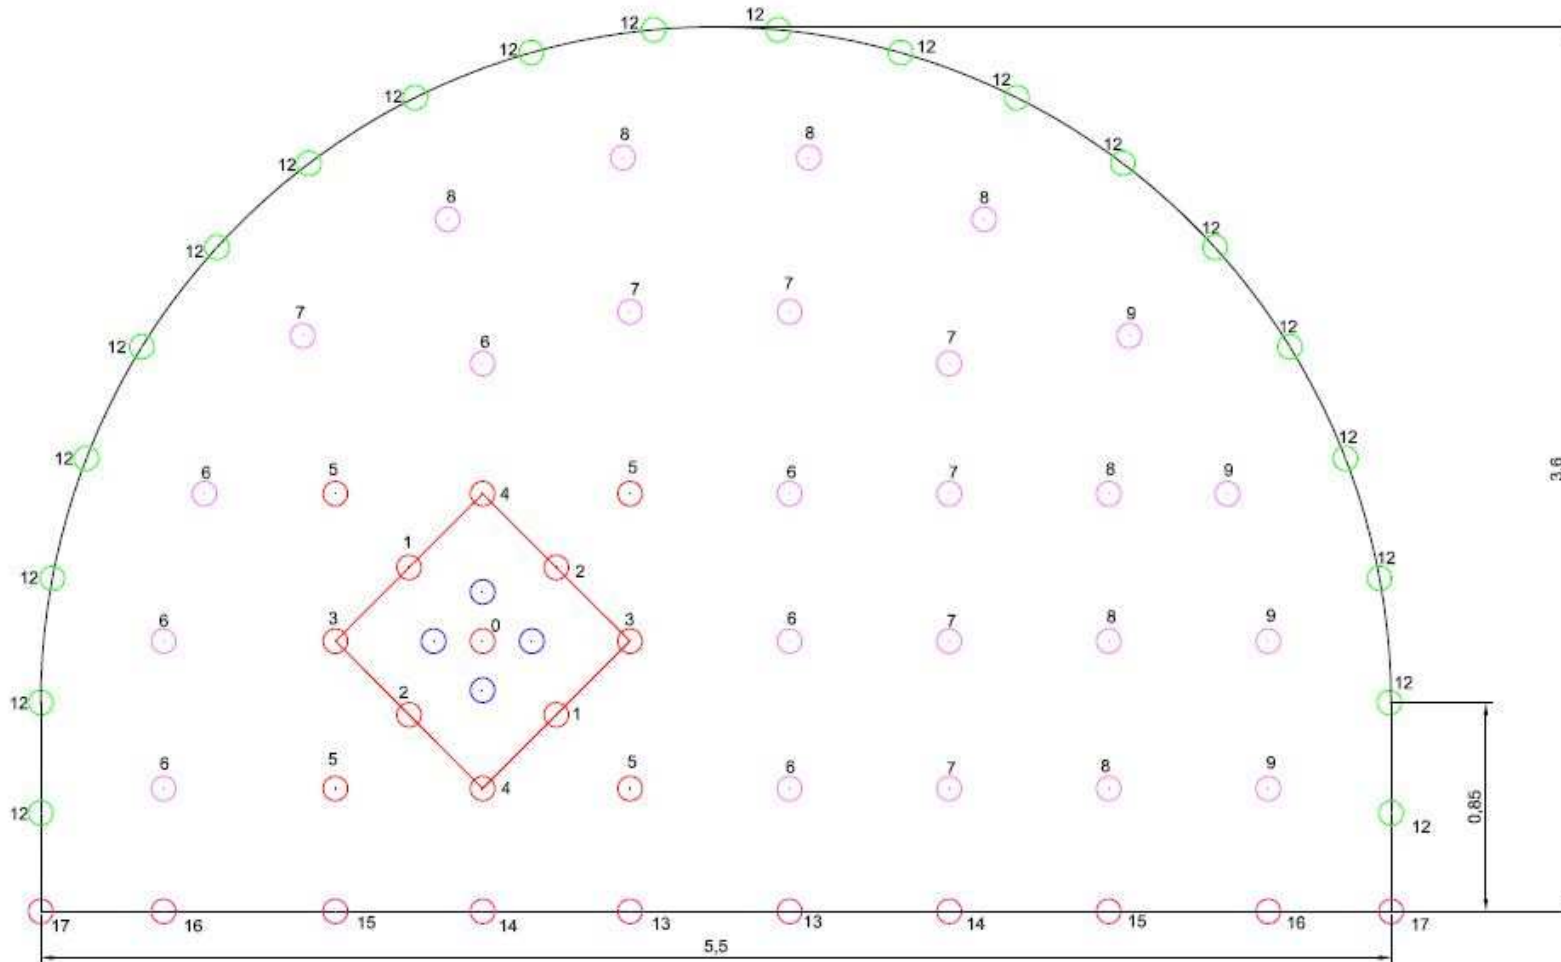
Esquema de la voladura de las galerías transversales
